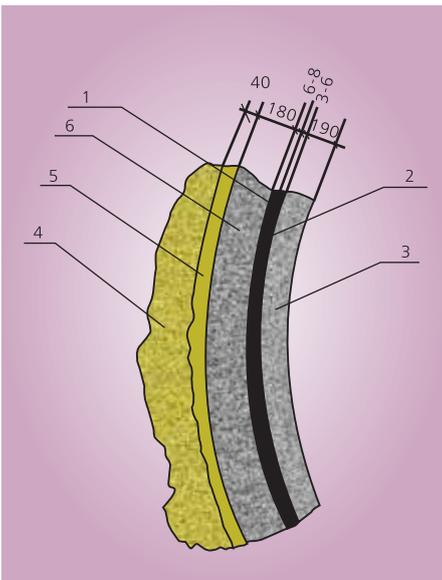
Конструктивная схема сечения стенки кабельного тоннеля: 1 – дренажно-защитный слой, 2 – гидроизоляция ПВХ, 3 – железобетонная обделка тоннеля, 4 – массив грунта, 5 – тампонаж, 6 – блочная крепь, 7 – дренажно-защитный слой из геотекстиля
